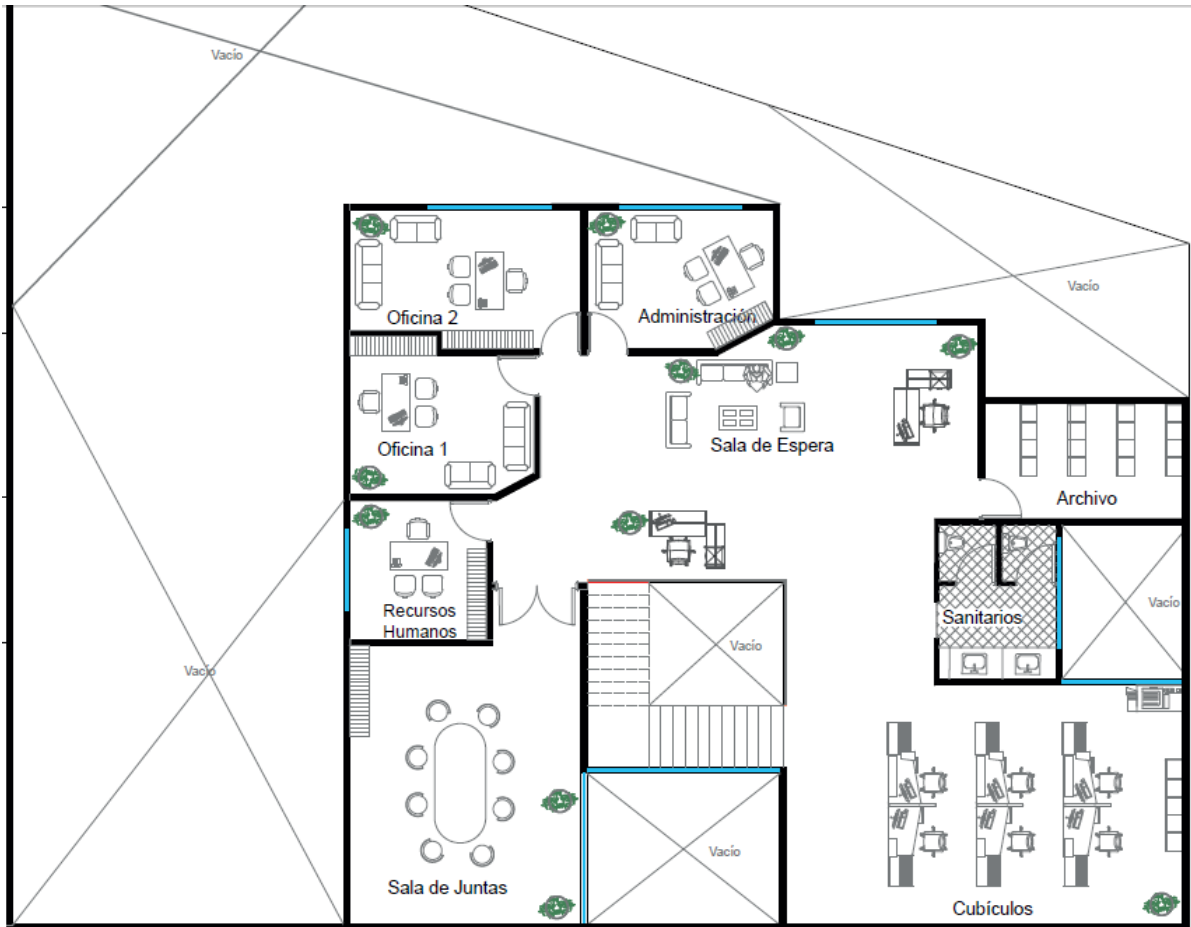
Plano arquitectónico de la planta que se desea construir con detalles de construcción en planta alta.
